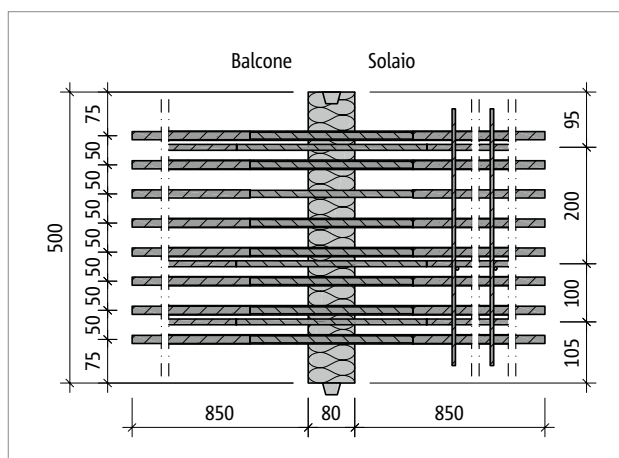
Schöck Isokorb® T tipo K-M14-V1: pianta del prodotto
